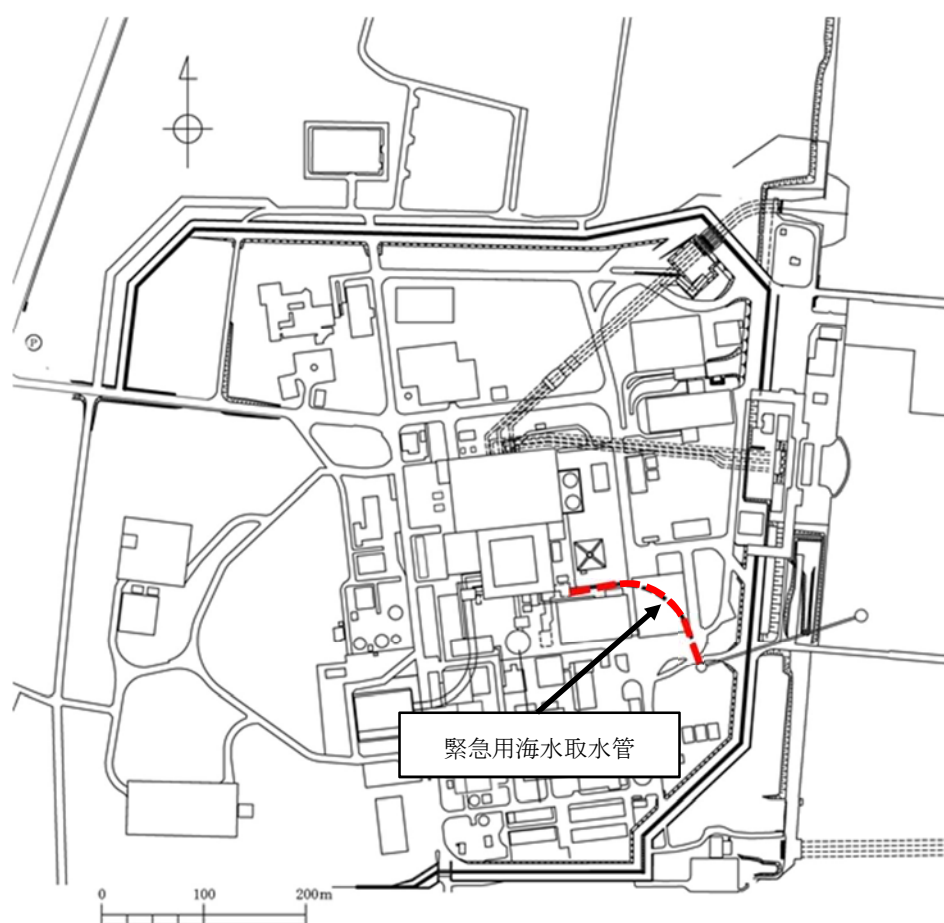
(1) 緊急用海水取水管 平面位置図 (全体図)
